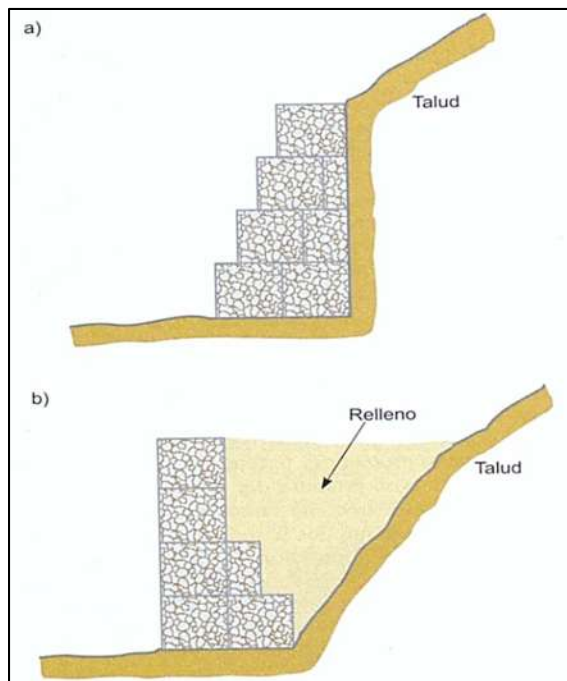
Muros de gaviones con el intradós escalonado a); y con el trasdós escalonado, con relleno entre el muro y el talud b). González de Vallejo et al, 2004.
